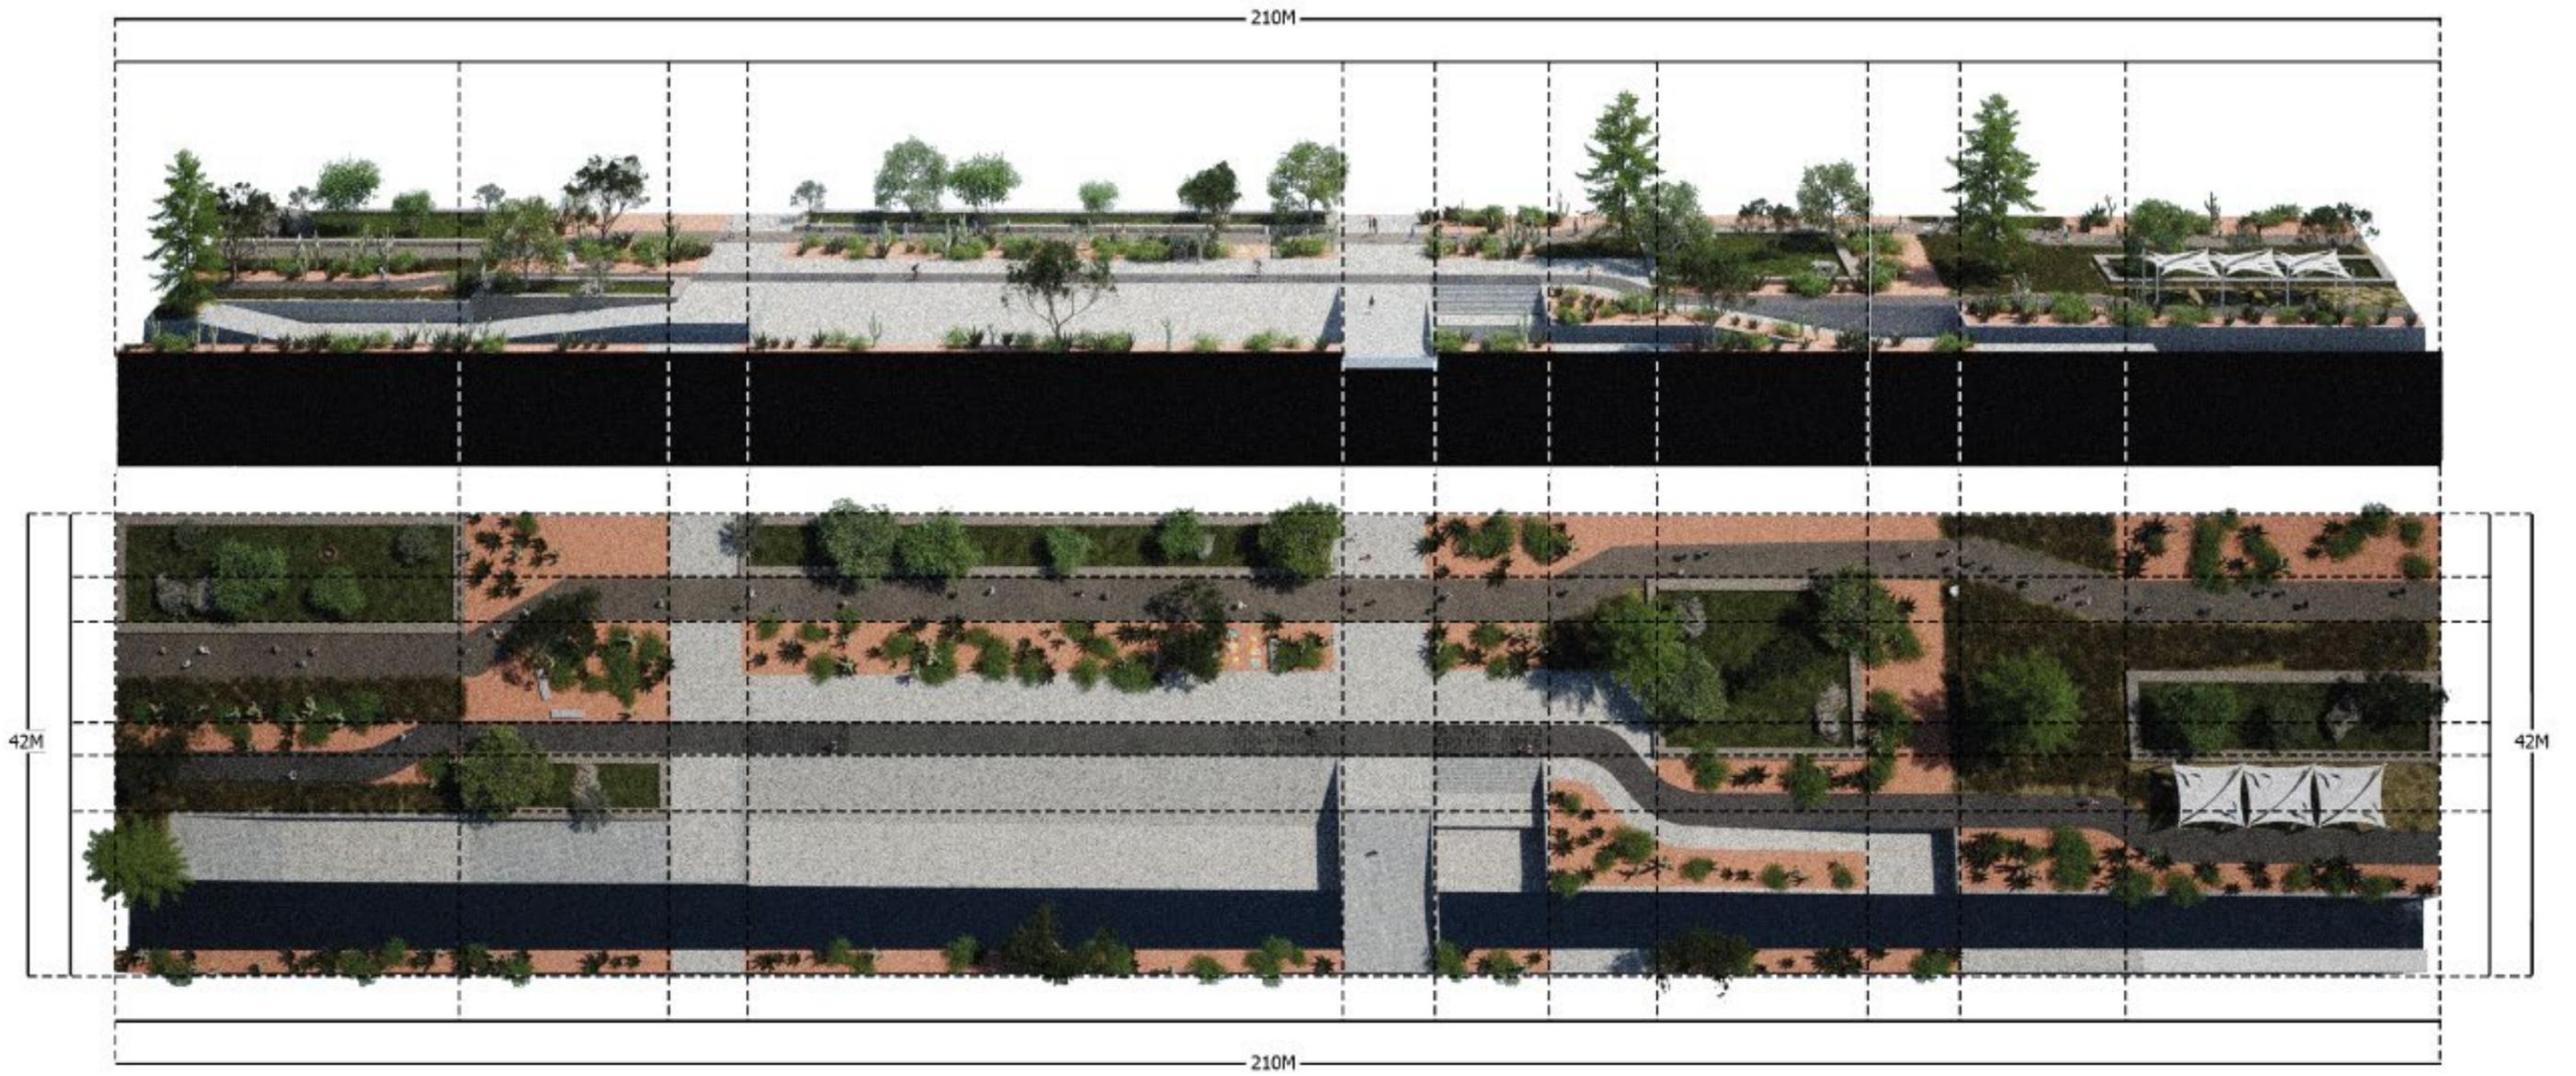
Planimetría parque en época esival. Fuente: Elaboración propia
